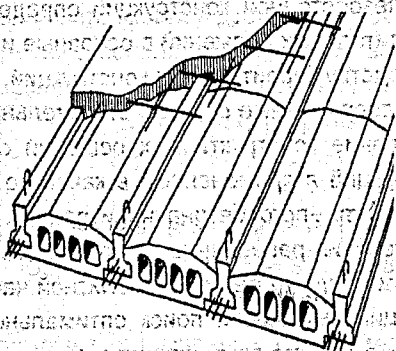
Общий вид оптимизируемой сборно-монолитной железобетонной балочной конструкции междуэтажного перекрытия с вкладышами из пенополистирола.
